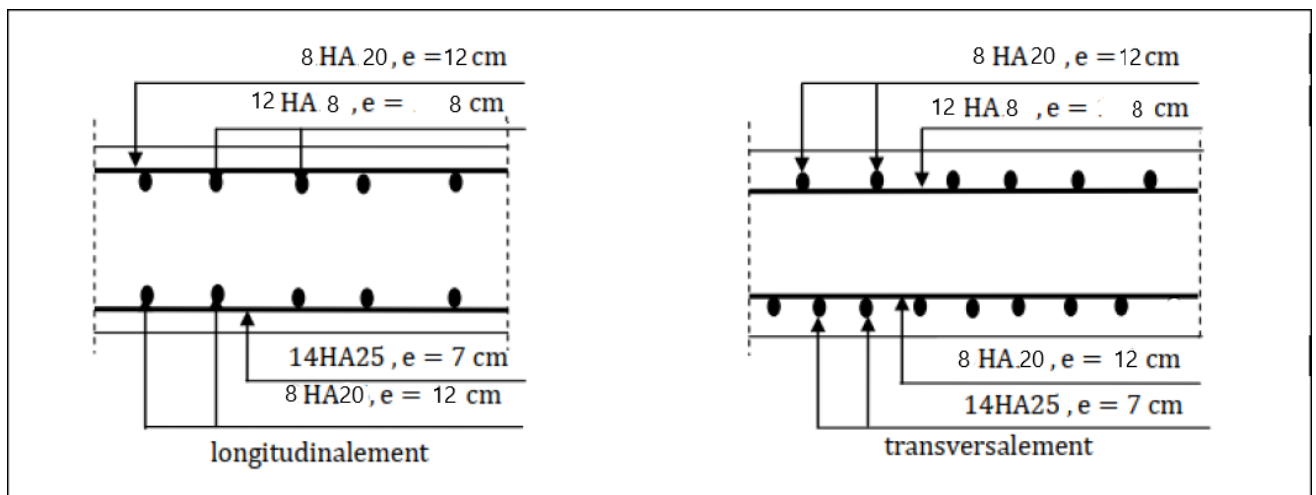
schéma de ferrailage de la dalle de transition.
